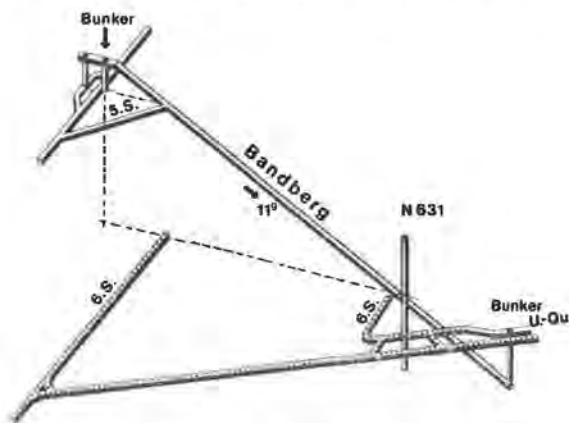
Plan incliné entre le 5e et le 6e étage.
